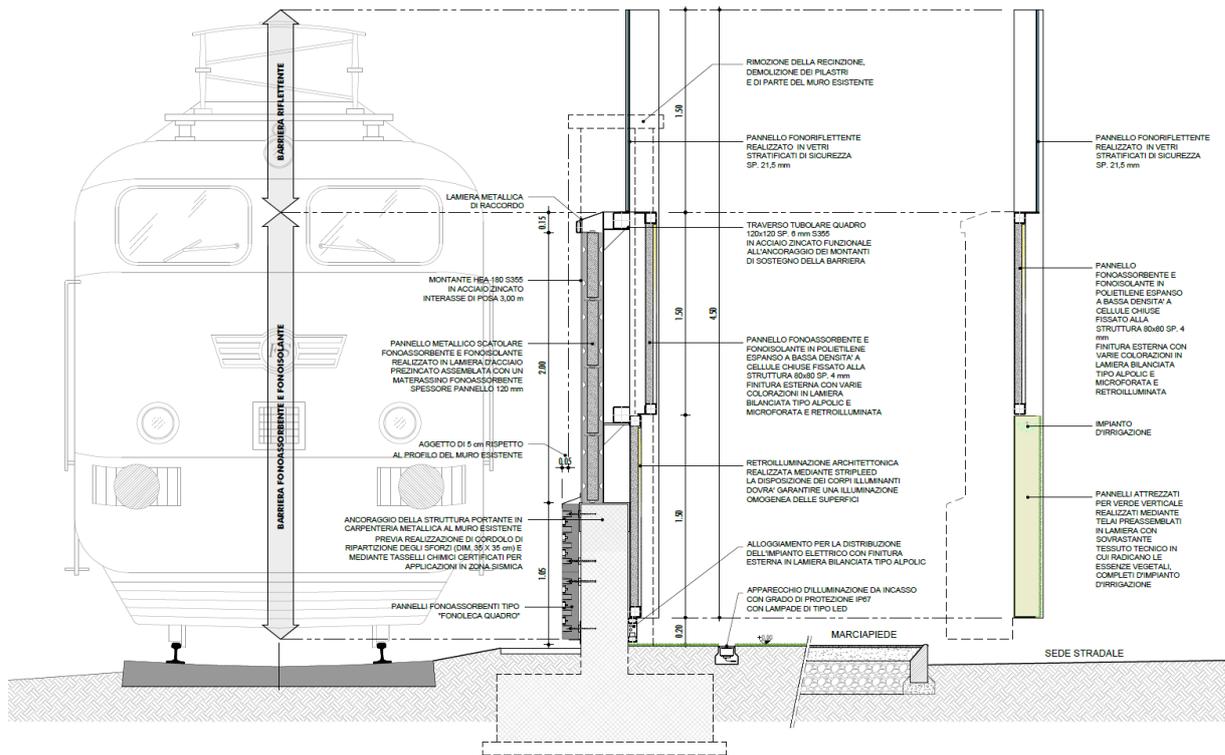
Progetto definitivo - Protezione antifonica H=4,50 m, sezione tipo (a)
